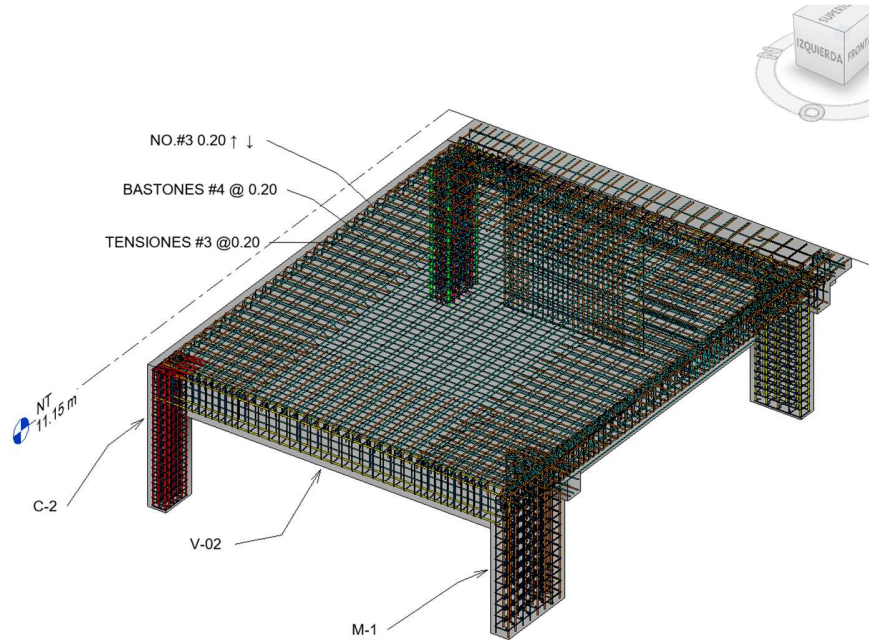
Anclaje de losa tradicional a un marco viga columna
